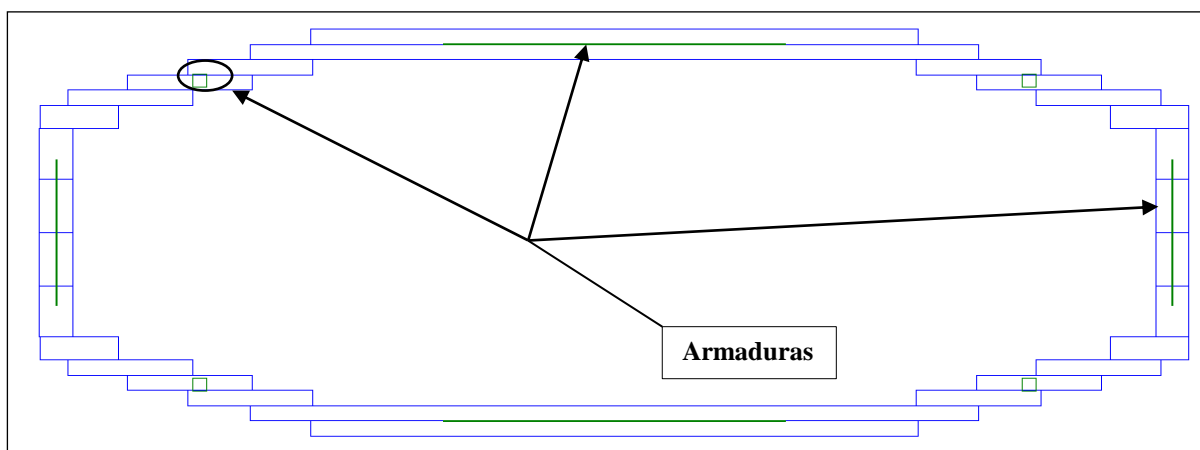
Pormenor das armaduras no P41 (em Evolution).
